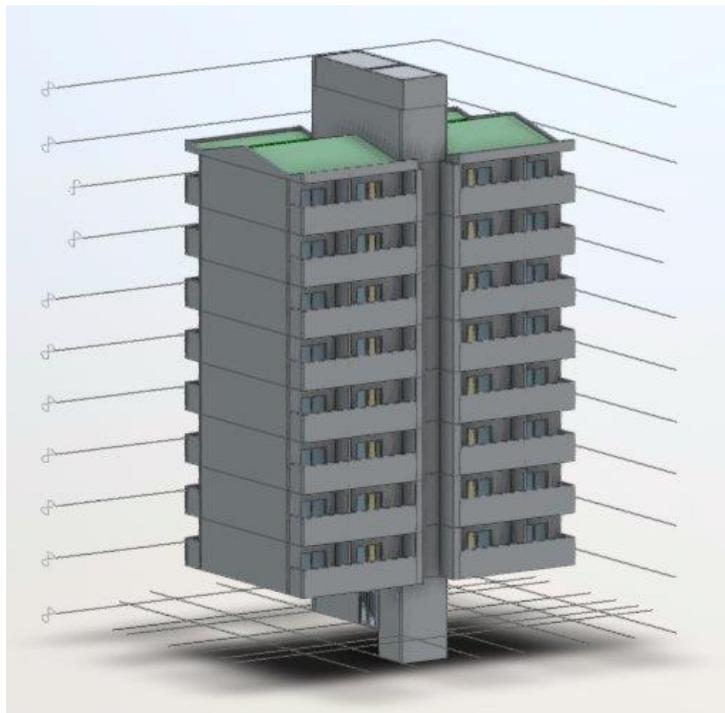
Vista tridimensional do modelo arquitetônico (sem pilares)
